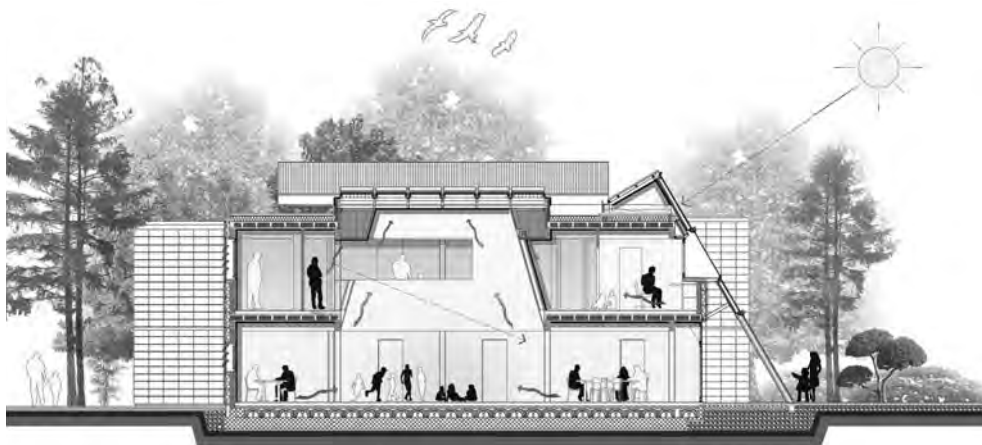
Sezione longitudinale dell'edificio (Fonte: documentazione progettuale fornita dallo studio di progettazione AIACE. Arch. Ettore Zambelli)
